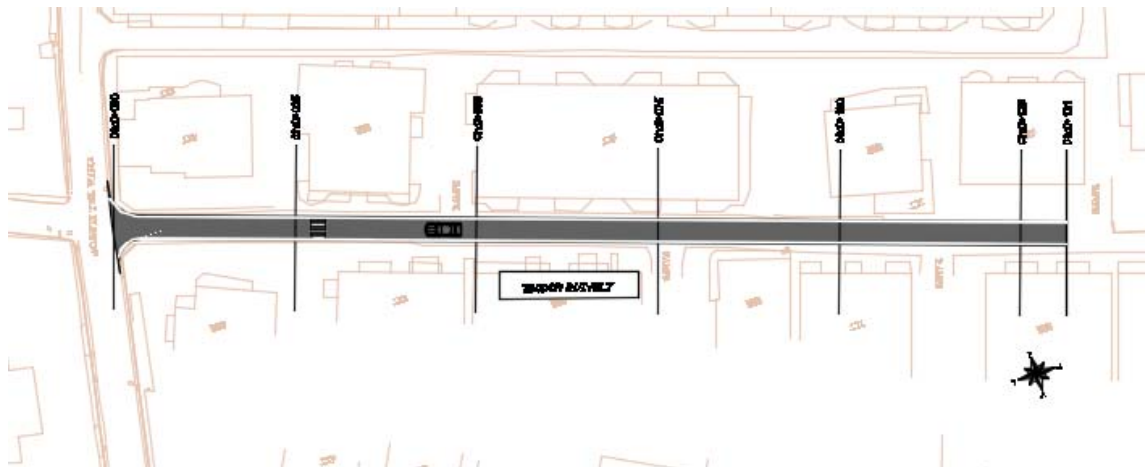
Planimetria e rruges Teodor Rusvelt- Blloku Nr.1
